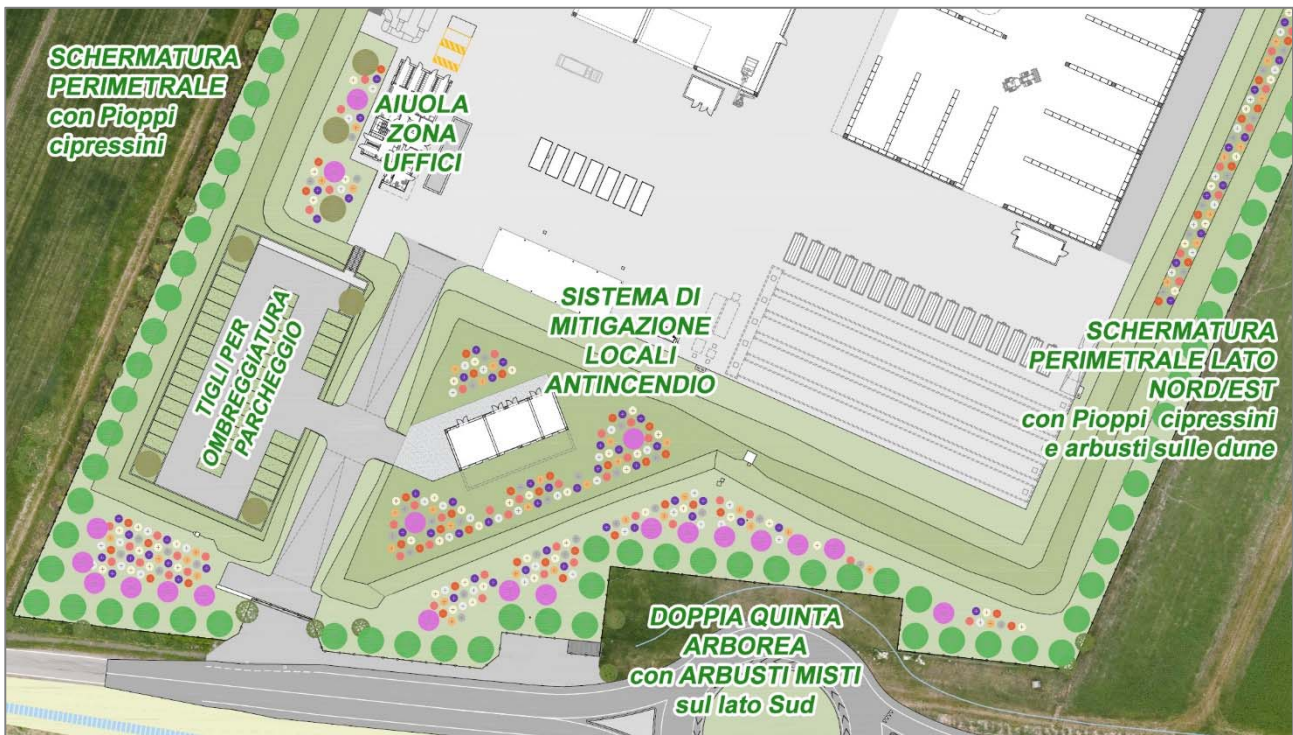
Estratto planimetrico con indicazione di massima delle opere a verde previste
